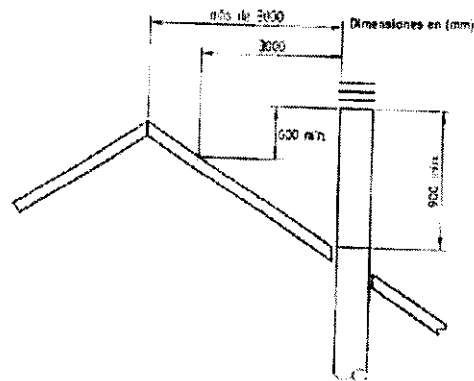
Techumbre – Ubicación del Terminal del Conducto y Sombrerete a más de tres (3) metros del Caballete.
